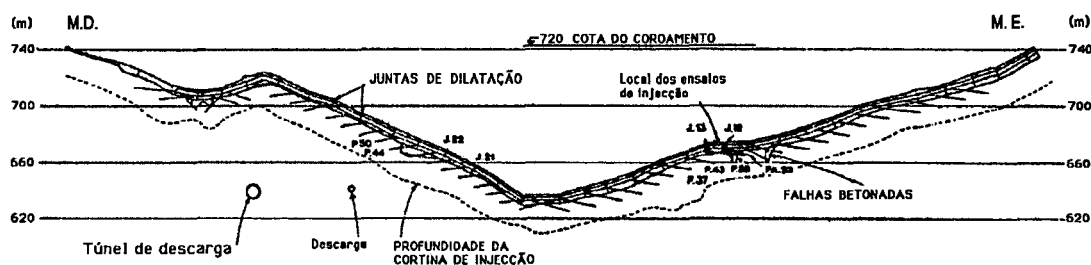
Localização dos furos de impermeabilização e drenagem sob o muro corta-águas da barragem de Paradela (Weyermann, 1958).
